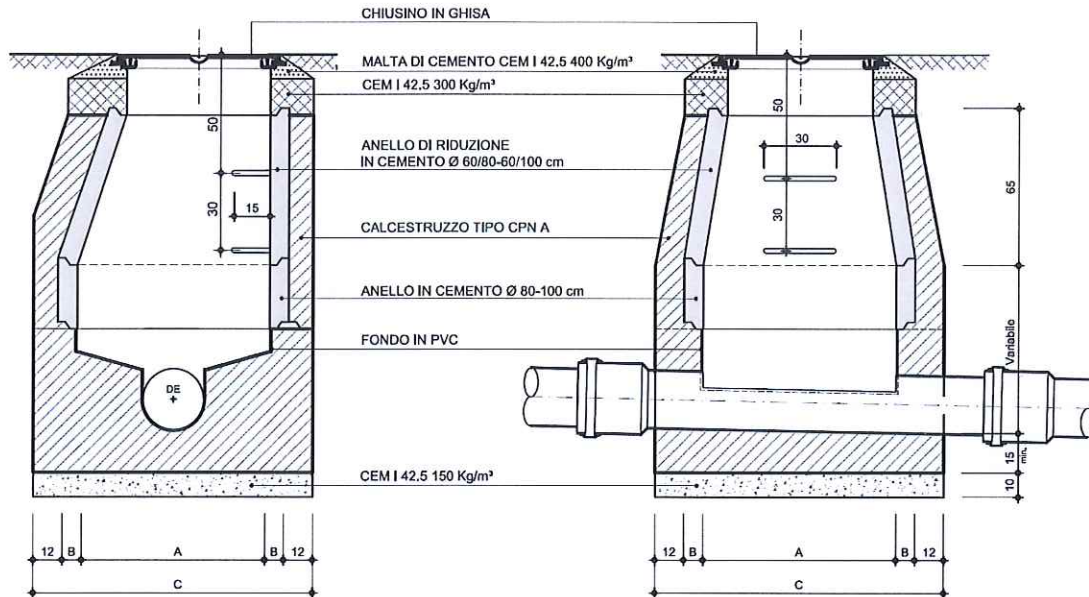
Sezioni tipo pozzetti con fondo in PVC
